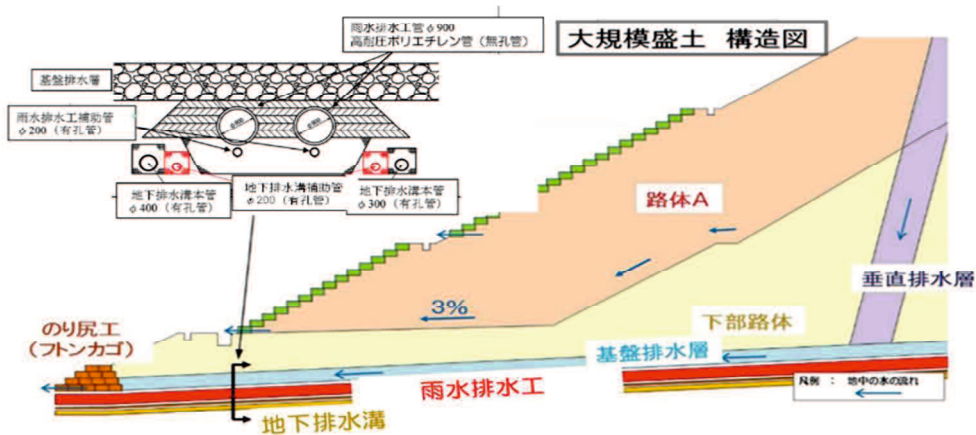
宝塚北 SA 盛土排水施設断面図
